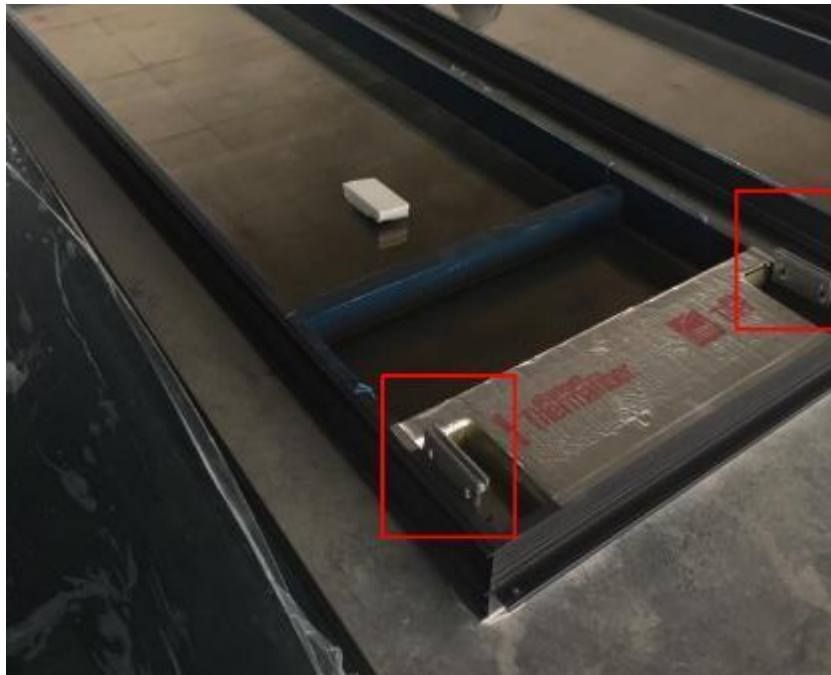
Anclajes adheridos al panel. Fuente: Propia (2019)
